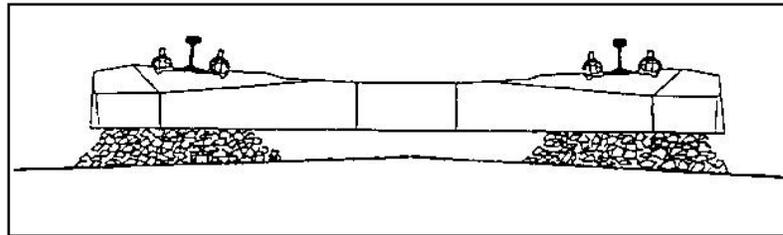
Sulco de balastro sob as travessas monobloco (ou madeira) [Adaptado de 41]
